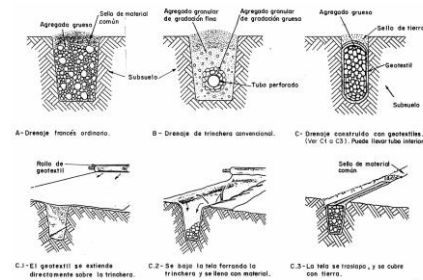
Detalle de zanjas superficiales (García López, 2014)
